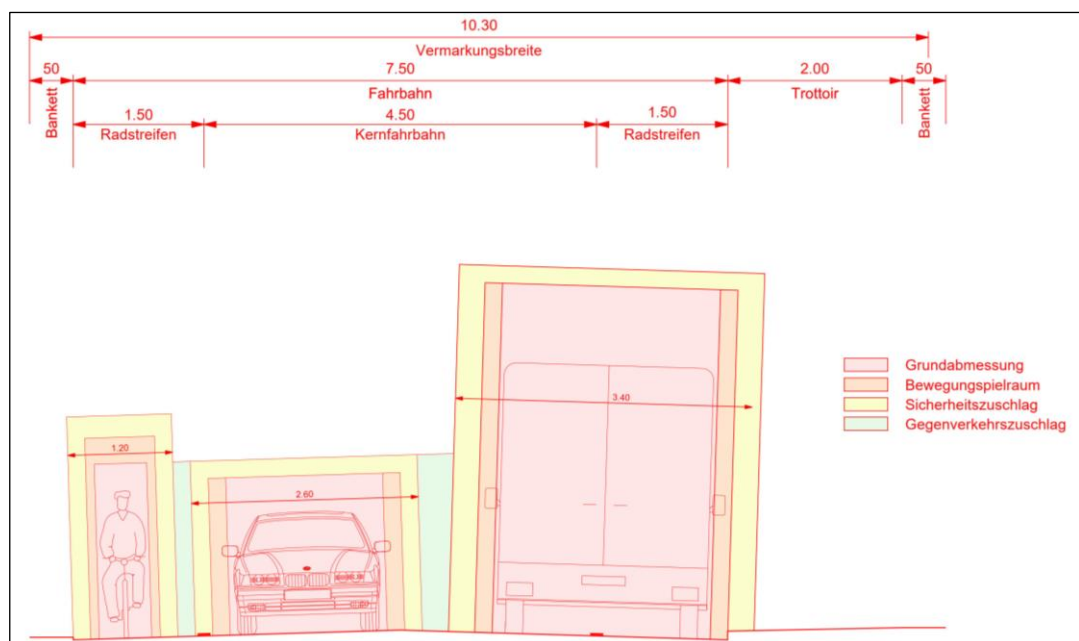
Geometrisches Normalprofil (GNP) Enggenhüttenstrasse
